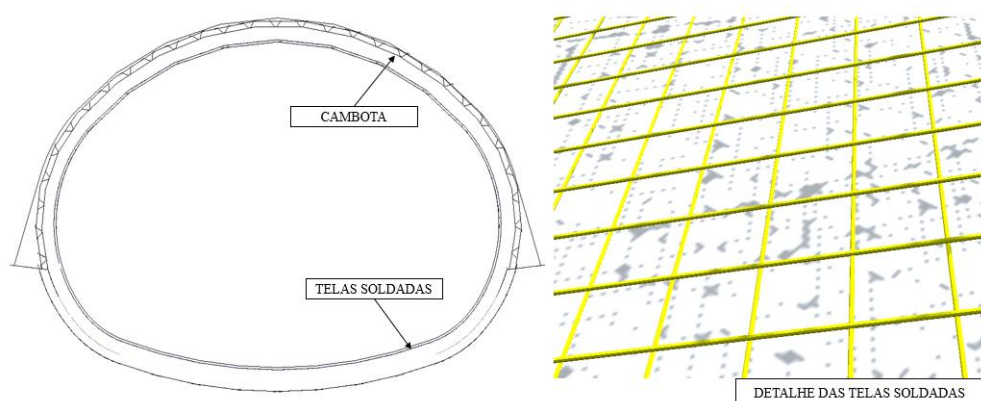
Seção de túnel com detalhe das armaduras geradas no Allplan
